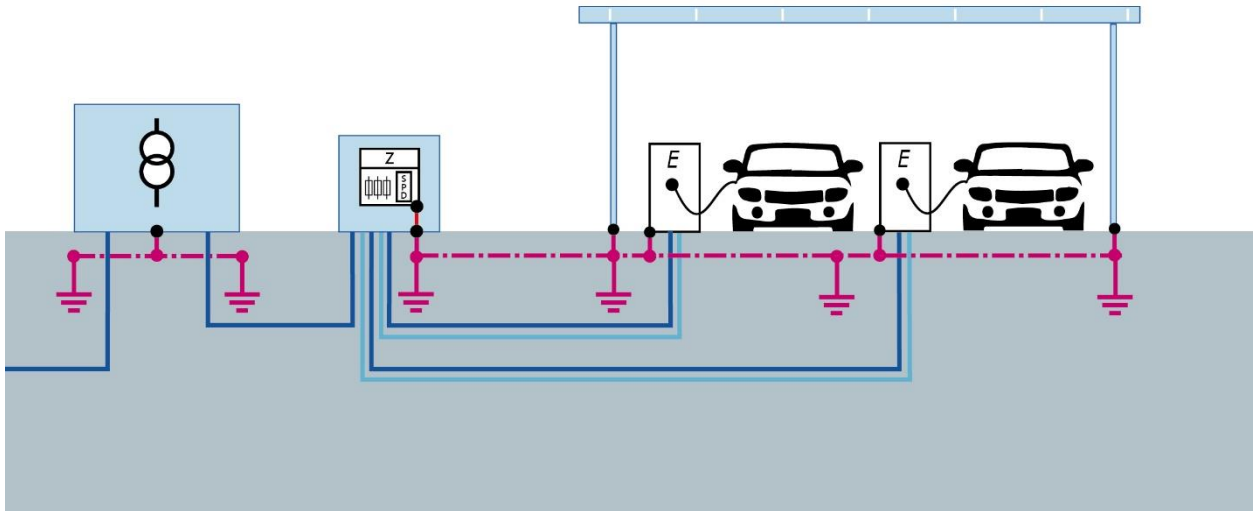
Ein Netzanschluss mit Erdungsanlage auf einem Grundstück – Beispiel Ladepark mit metallener Überdachung versorgt aus Ortsnetzstation
